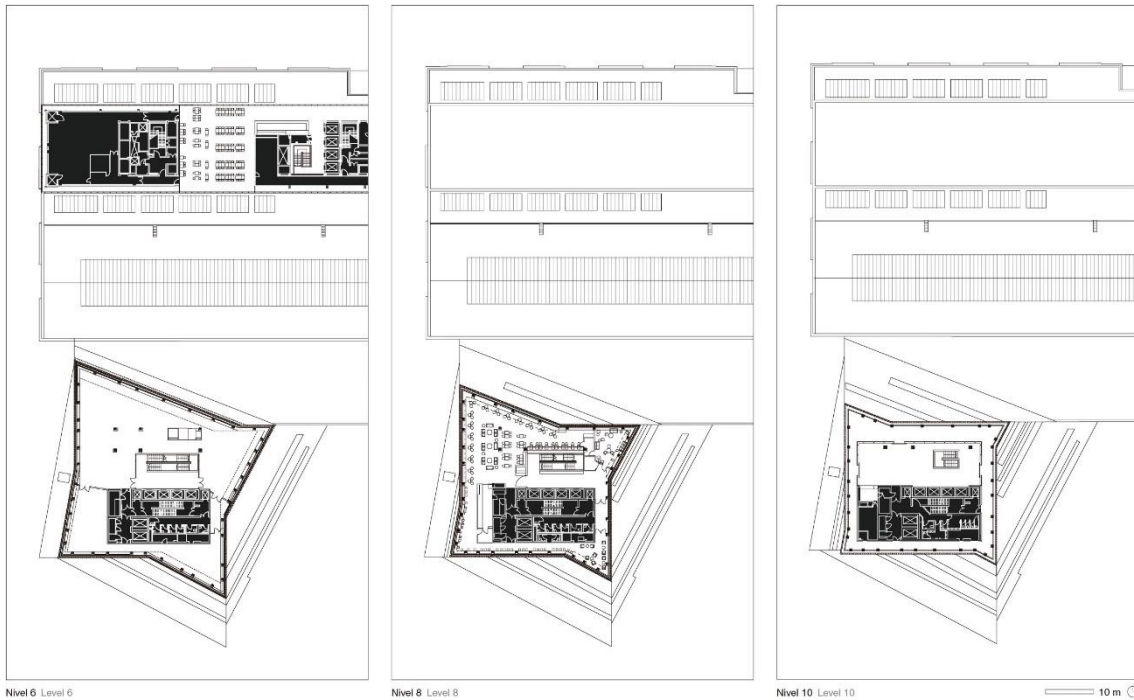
Planta arquitectónica del sexto, octavo y decimo nivel.
